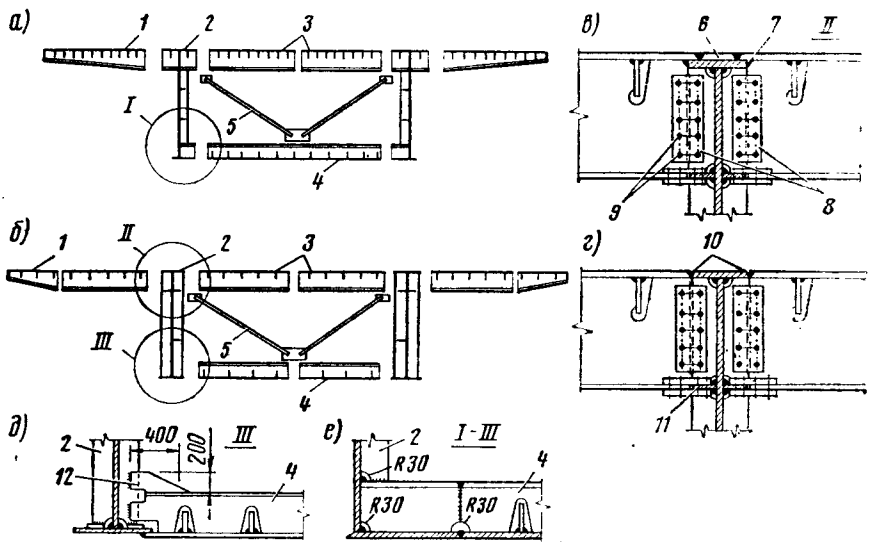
Монтажные блоки и стыки цельнометаллических пролетных строений: 1 — блоки консольных свесов верхней ортотропной плиты; 2 — блоки стенки; 3 — блоки верхней ортотропной плиты на участке между стенками; 4 — блок нижней ортотропной плиты; 5 — поперечные связи; 6 — монтажная вставка; 7 — угловой потолочный шов; 8 — двусторонняя накладка; 9 — высокопрочные болты; 10 — стыковой сварной шов; 11 — продольное ребро жесткости
